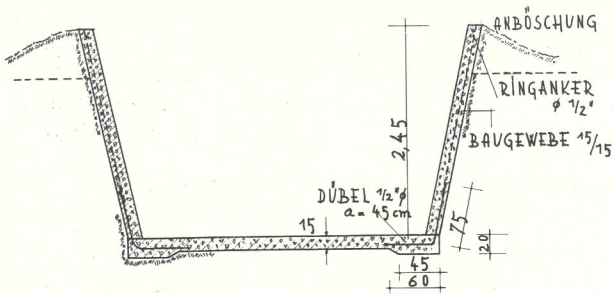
(oben): Grabensilo mit eingeschalteten Stahlbetonwänden.
